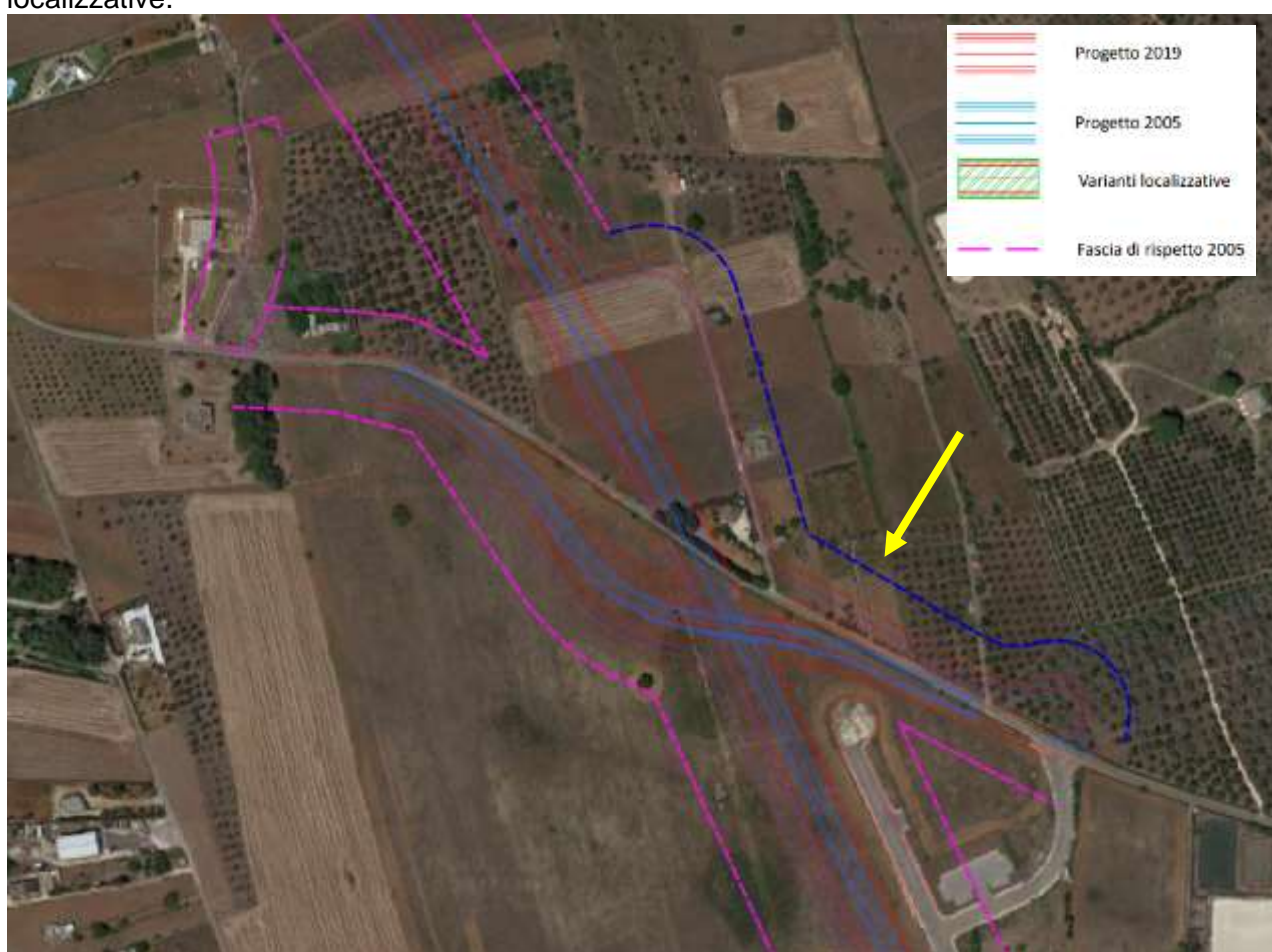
Scavalco 3 CV10 con indicazione dell'adeguamento della fascia di rispetto 2005 sulla base del progetto approvato.
